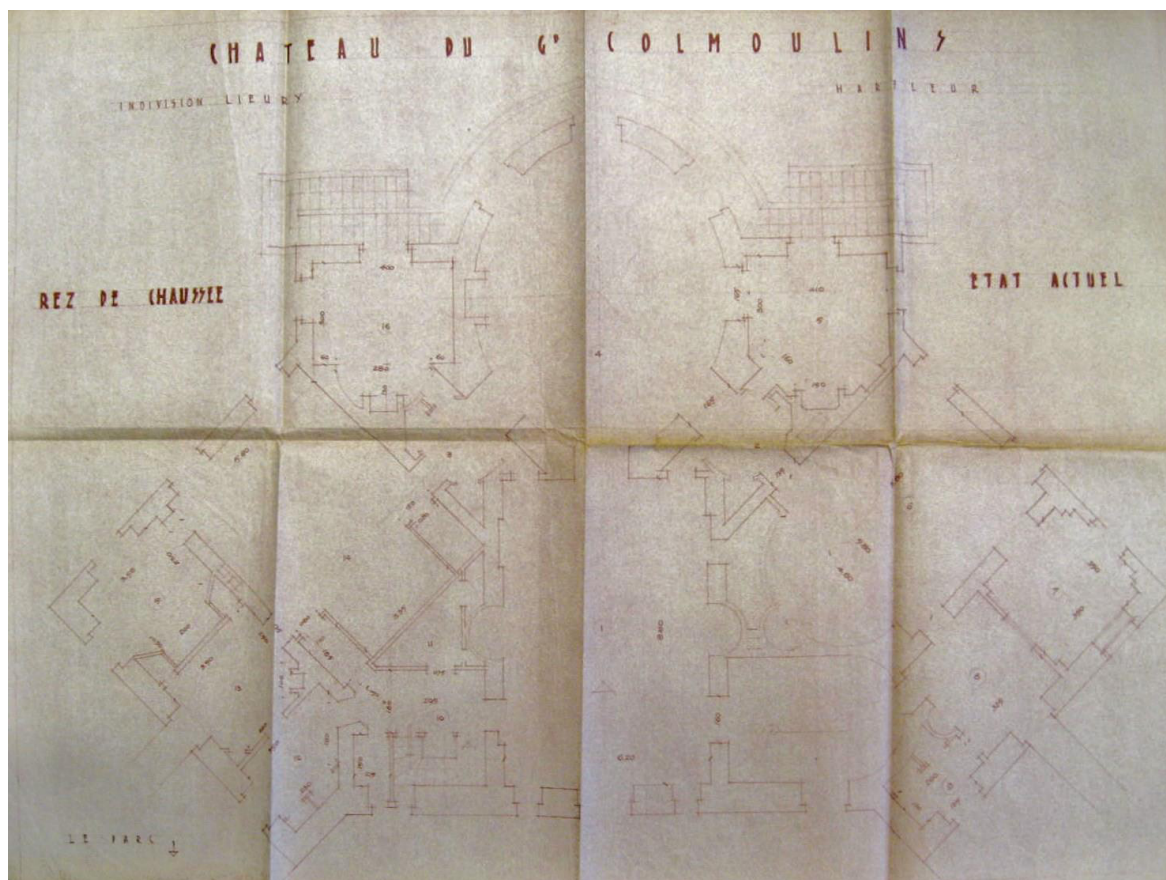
1947 Plan du rez-de-chaussée pour la restauration du château de Colmoulins par l'architecte Loisel. ADSM 238 W 4938.
